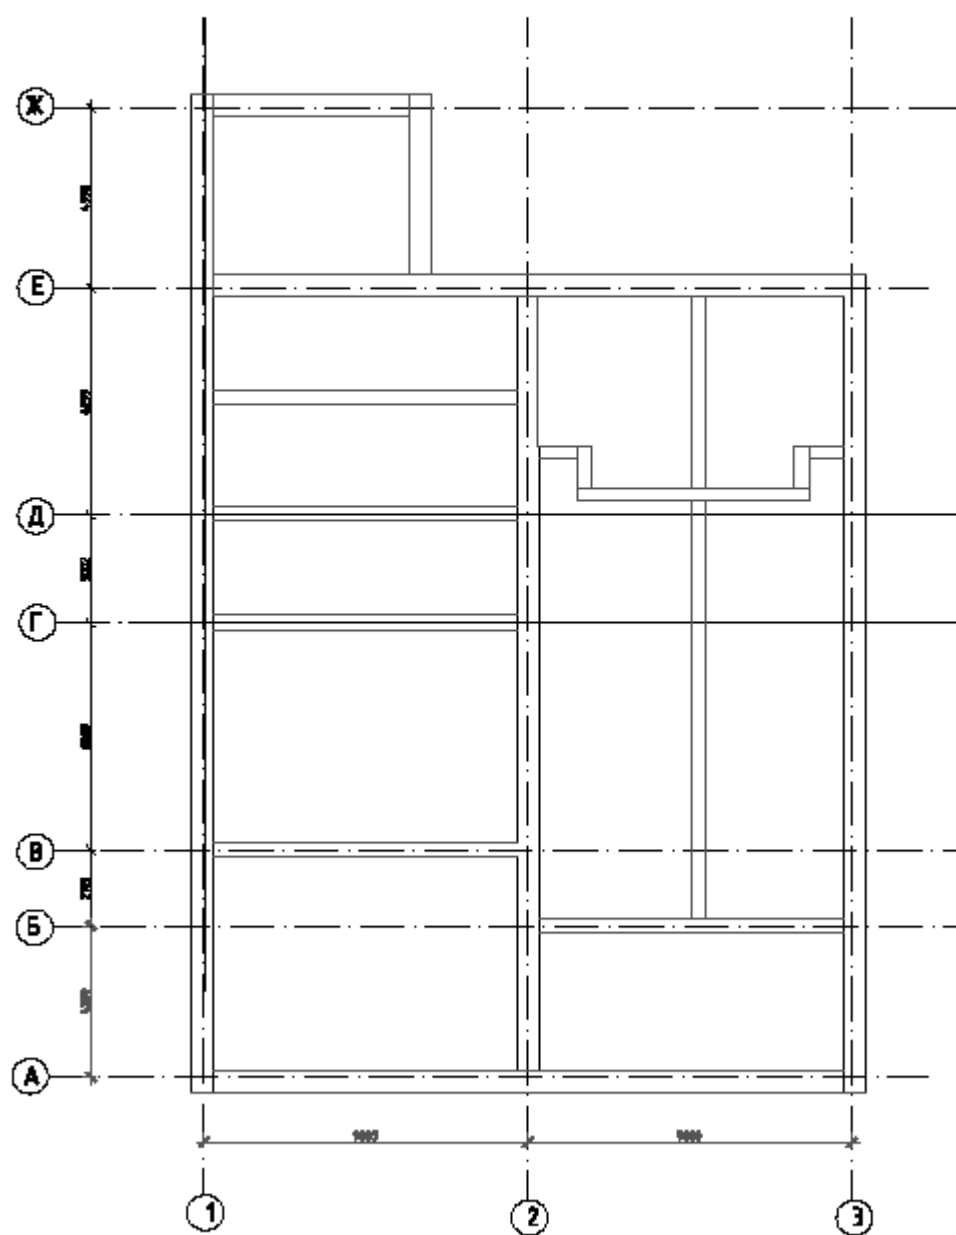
План фундаментов на отм. -3,28 м.
